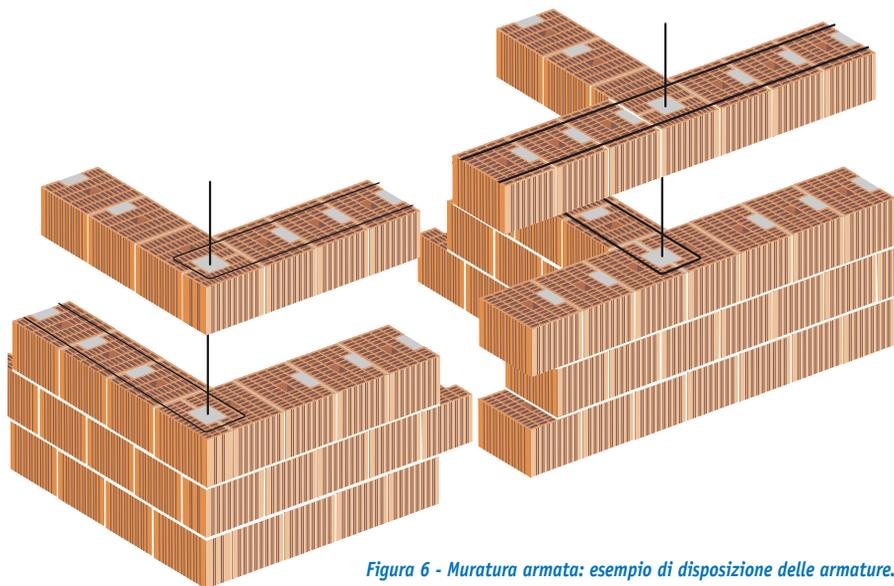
Muratura armata: esempio di disposizione delle armature.
